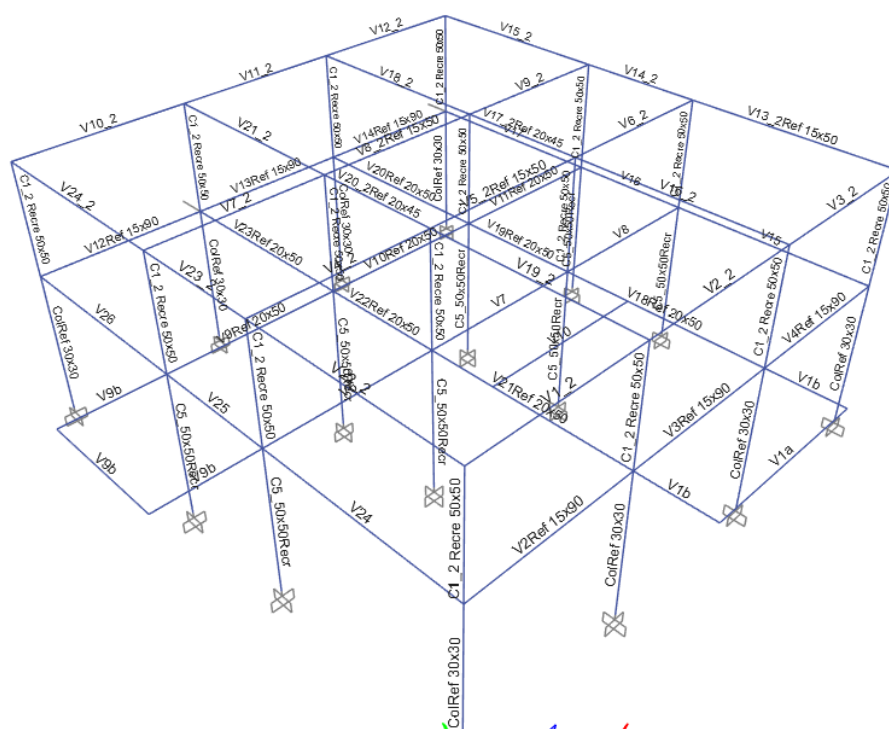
23 Reforzamiento por encamisado/recrado para la estructura
